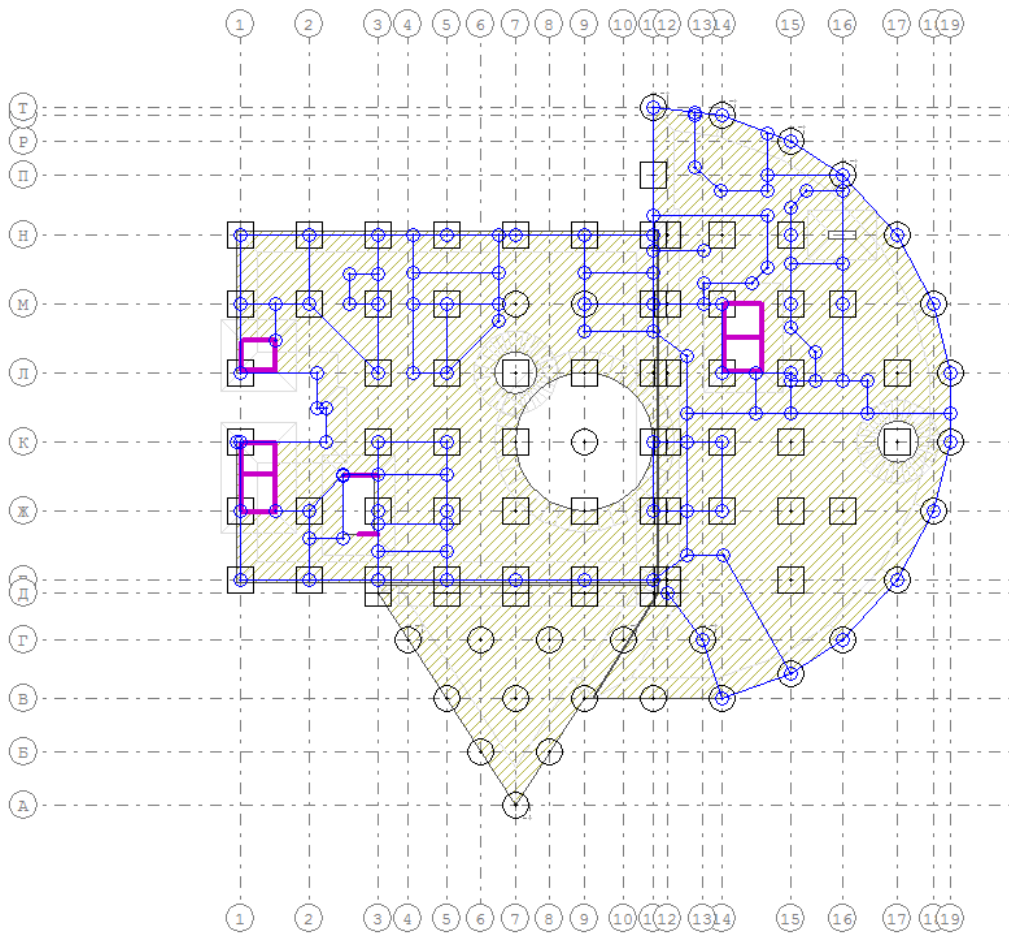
Розрахункова схема 1 поверху будівлі
